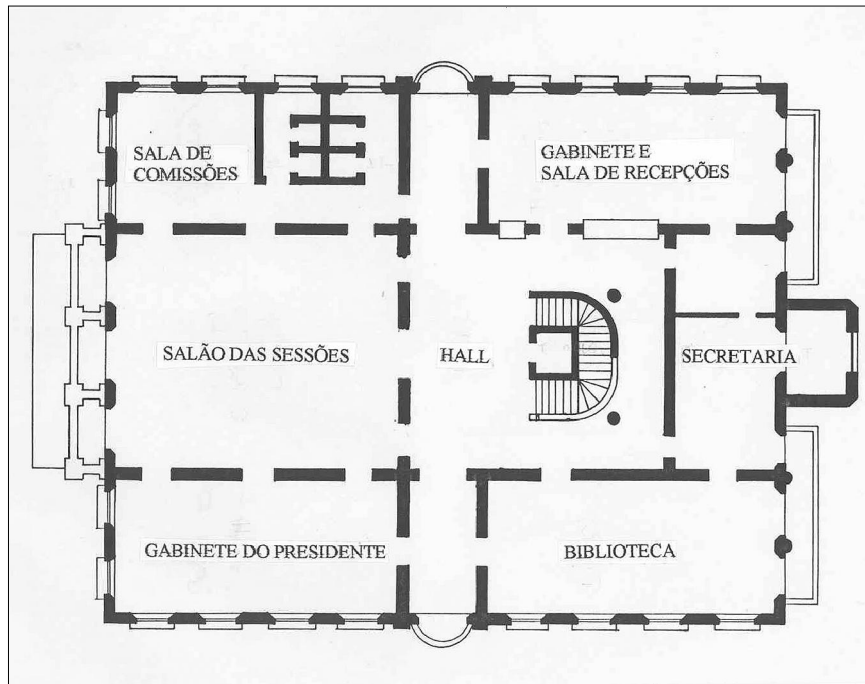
Paço Municipal. Planta 2º Pavimento. Levantamento arquitetônico – 1971.
